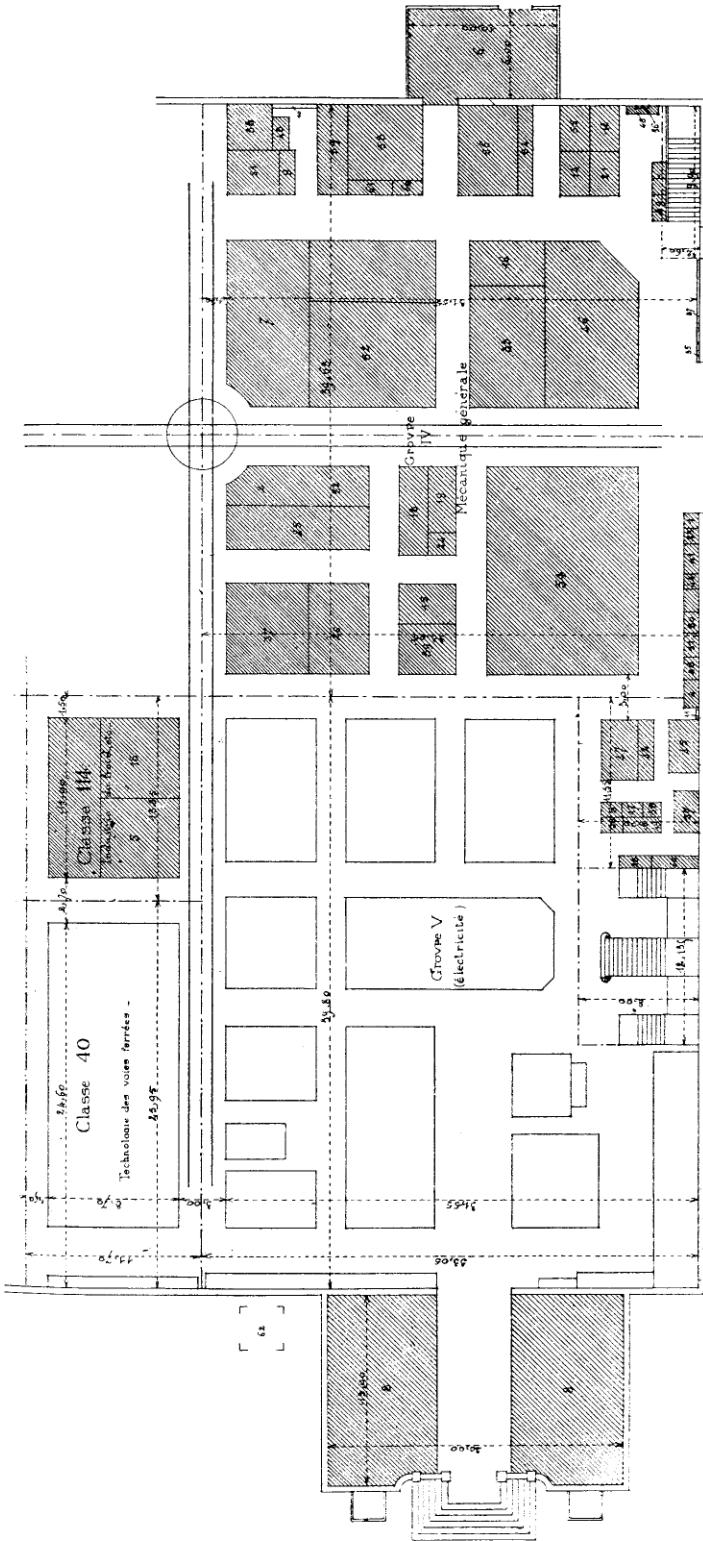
Plan d'ensemble du Groupe IV (Mécanique générale) de la Section Française.
